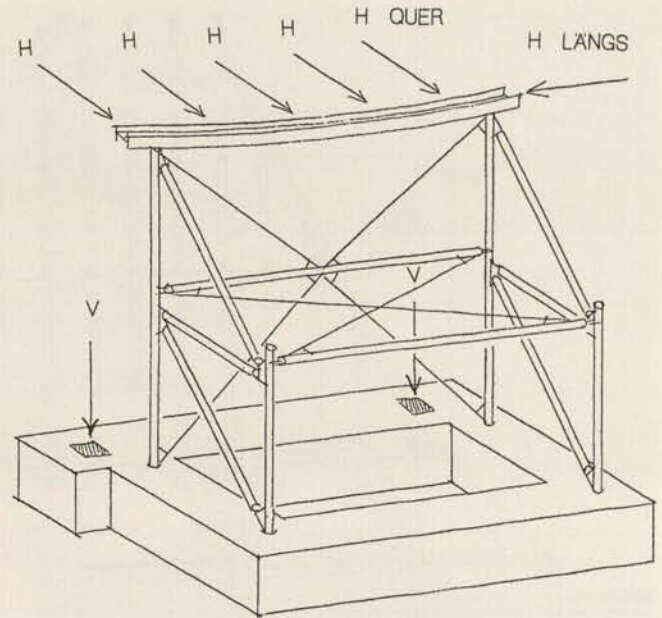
Stützgerüst beiderseits des Haupteingangs mit Fundament und Darstellung der am Gerüst wirkenden Kräfte.
